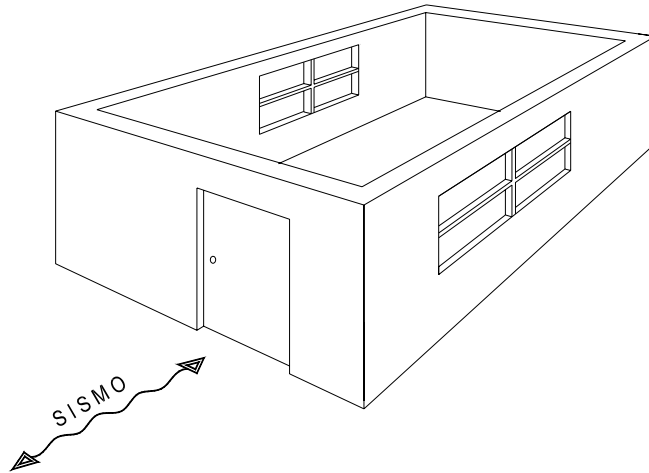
CASA DE ADOBE BAJO LA ACCIÓN SÍSMICA
